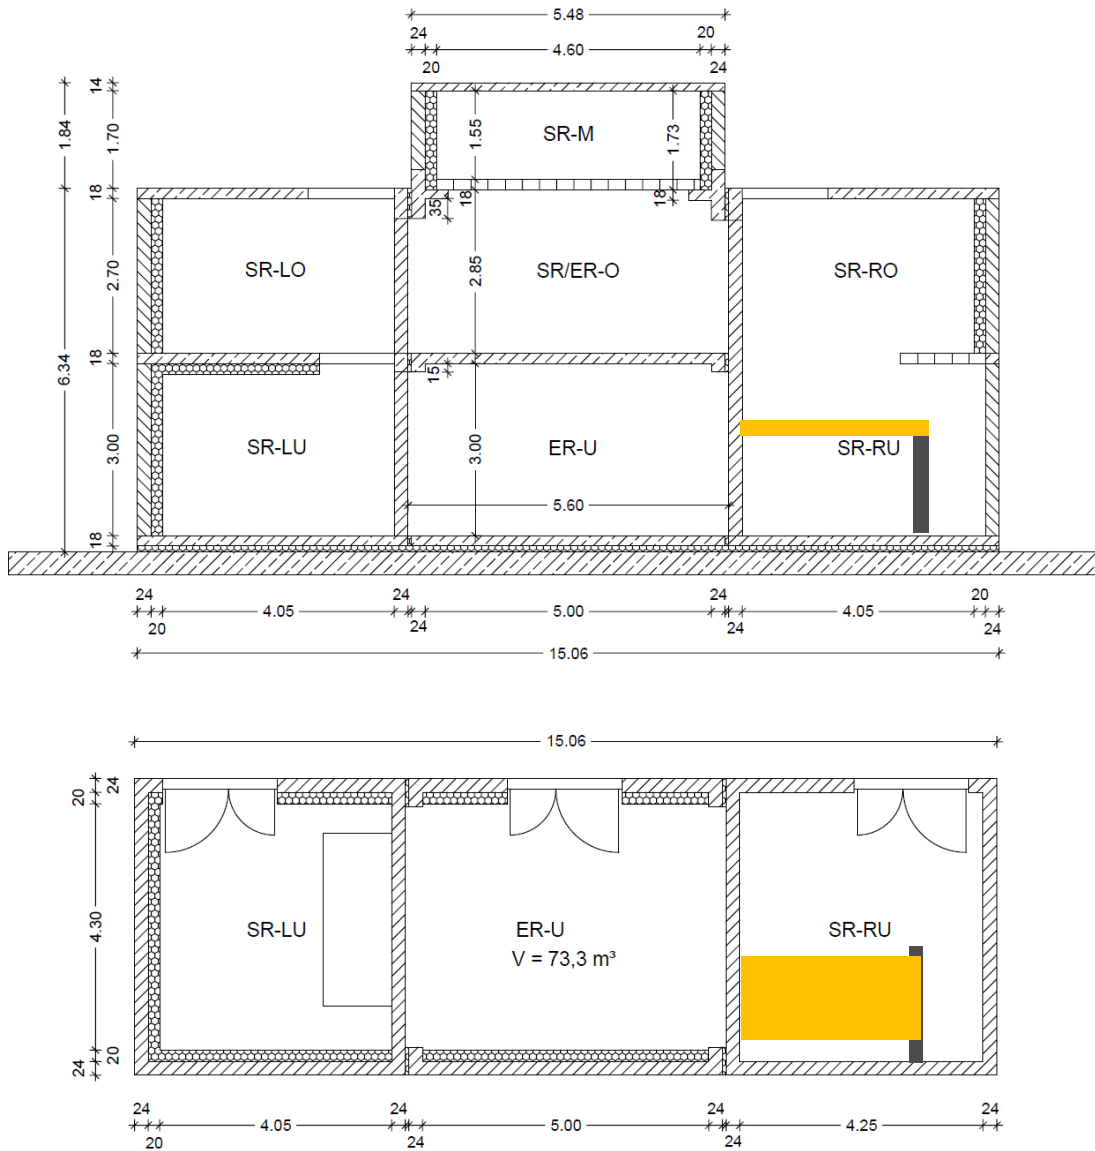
Grundriss und Schnitt des Treppenprüfstandes mit Skizzierung der Prüfaufbauten (nicht maßstäblich) mit Referenztreppenpodest (gelb) und Hilfswand (grau). Der Raum mit der Bezeichnung ER-U ist der Empfangsraum für die horizontale Trittschallübertragung
